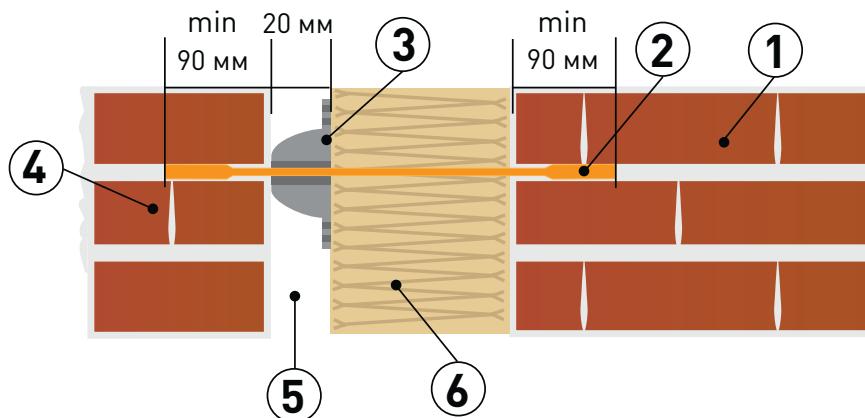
Схема установки связей 1) в основном поле стены, 2) угла здания в системе слоистой кладки
